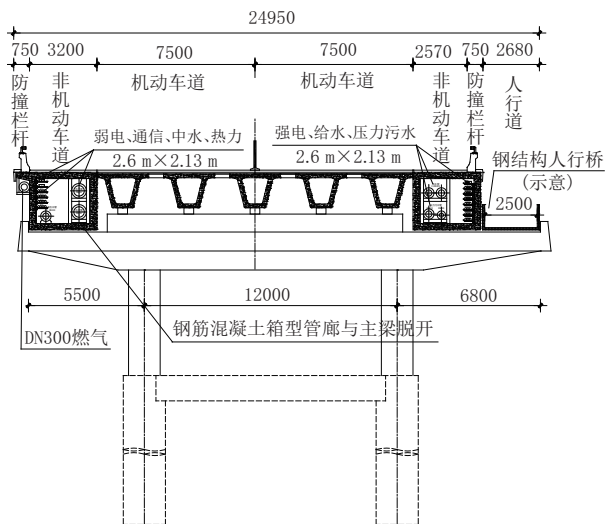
预制管廊+桥侧人行道方案断面图(单位:mm)
